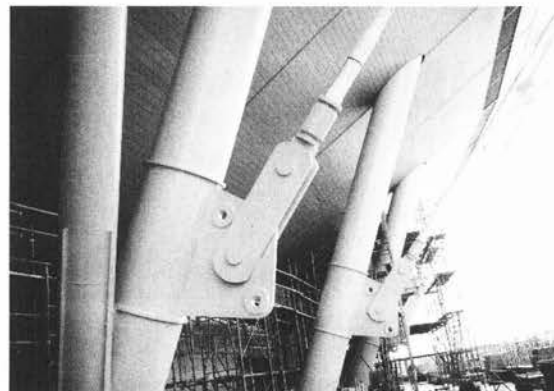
ケーブル定着構造の例（建築構造物）
